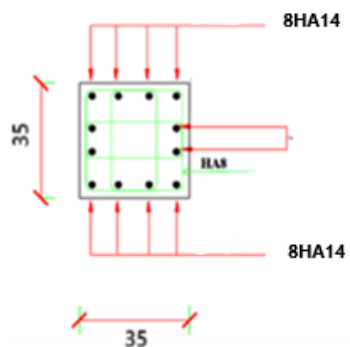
SCHEMA DE FERRAILAGE DES POTEAUX
